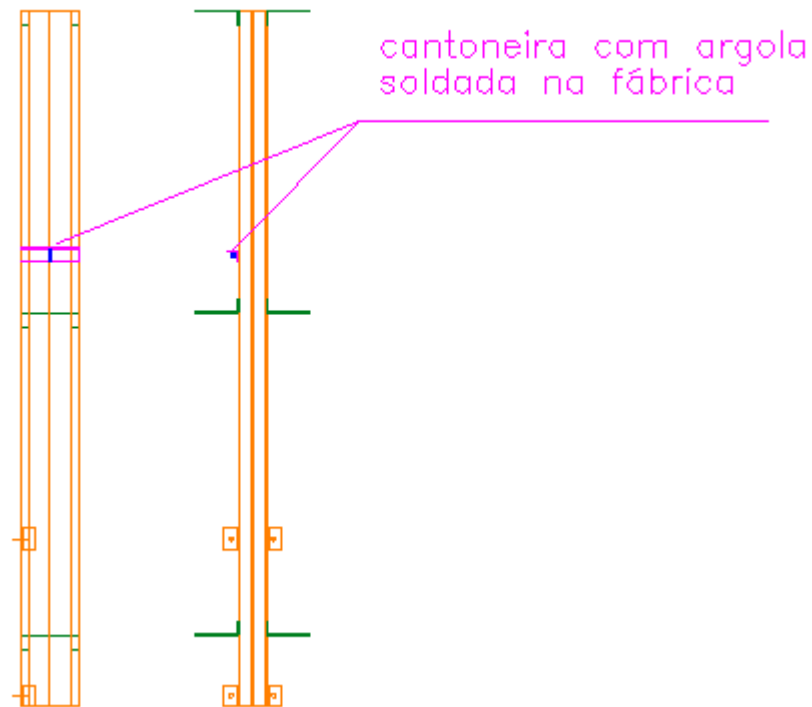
Detalhe da peça nos pilaretes para fixação cabo de vida
